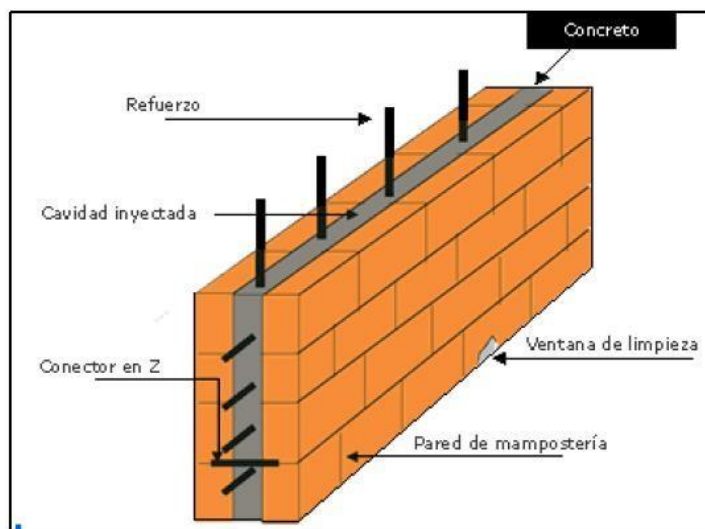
Mampostería de cavidad reforzada. (Revista Construdata, 2001).
